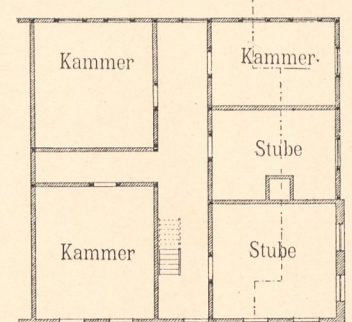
Bauernhaus Nr. 127 in Babenhausen. Obergeschoss.
